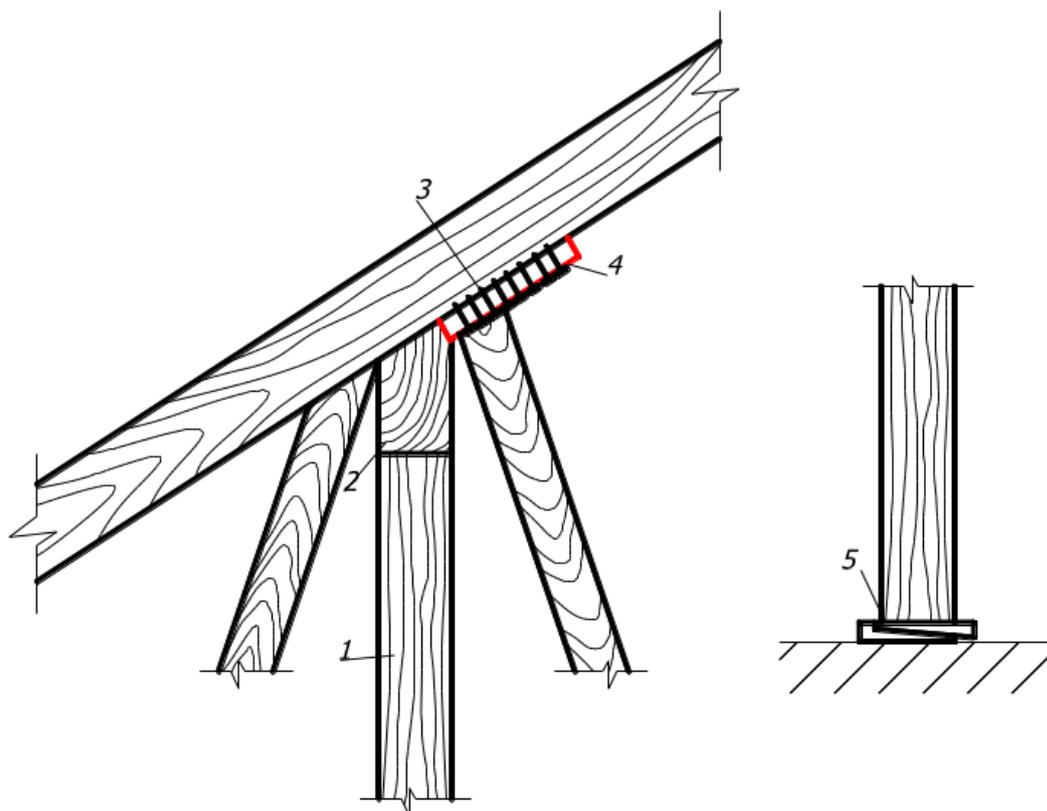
Вывешивание конструкции: 1 – временные стойки; 2 – поперечный прогон; 3 – гвозди; 4 – подкладка; 5 – клинья из твердой древесины
